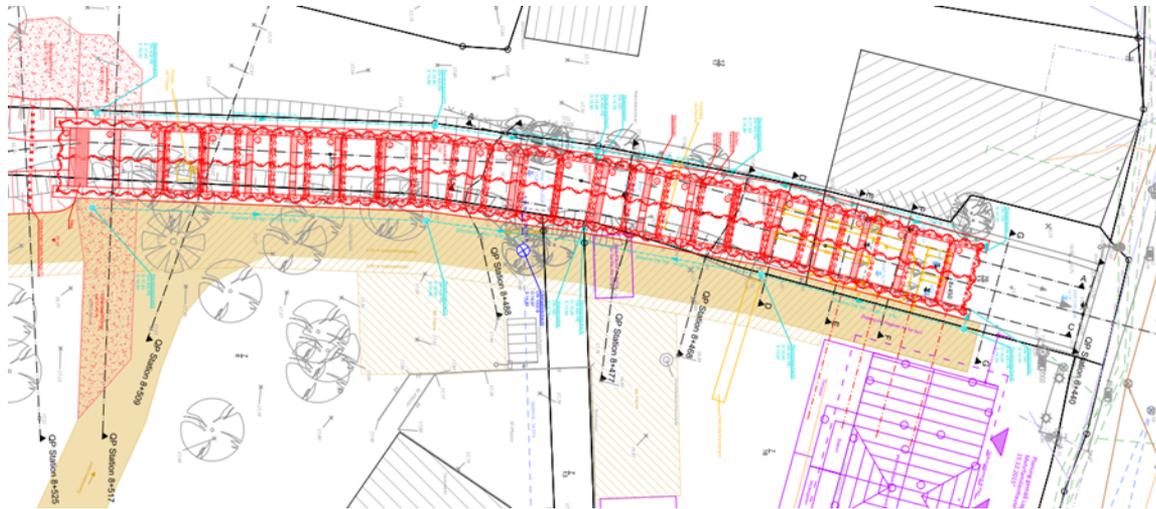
Lageplan Trogbauwerk mit Raugerinne, Planung Heidt + Peters
